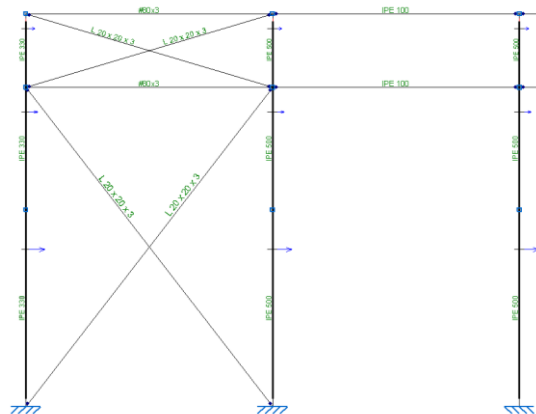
Detalle perfiles fachada lateral secundaria
